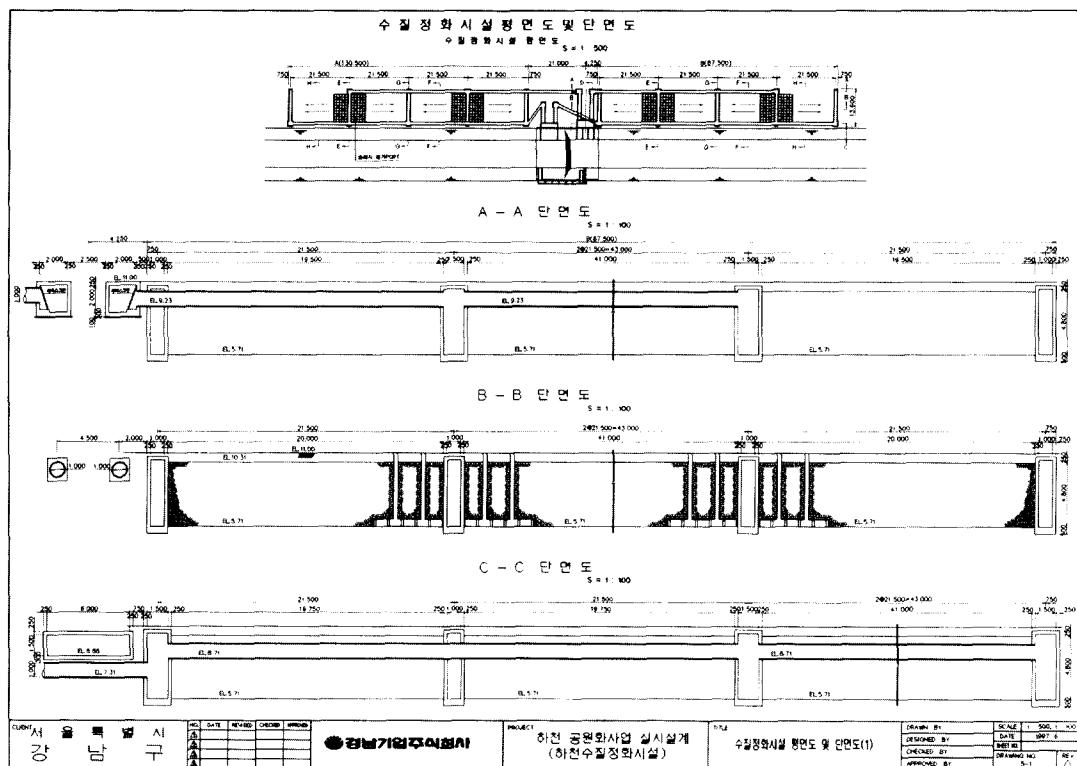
양재천 하천수질정화시설 평면도 및 단면도
